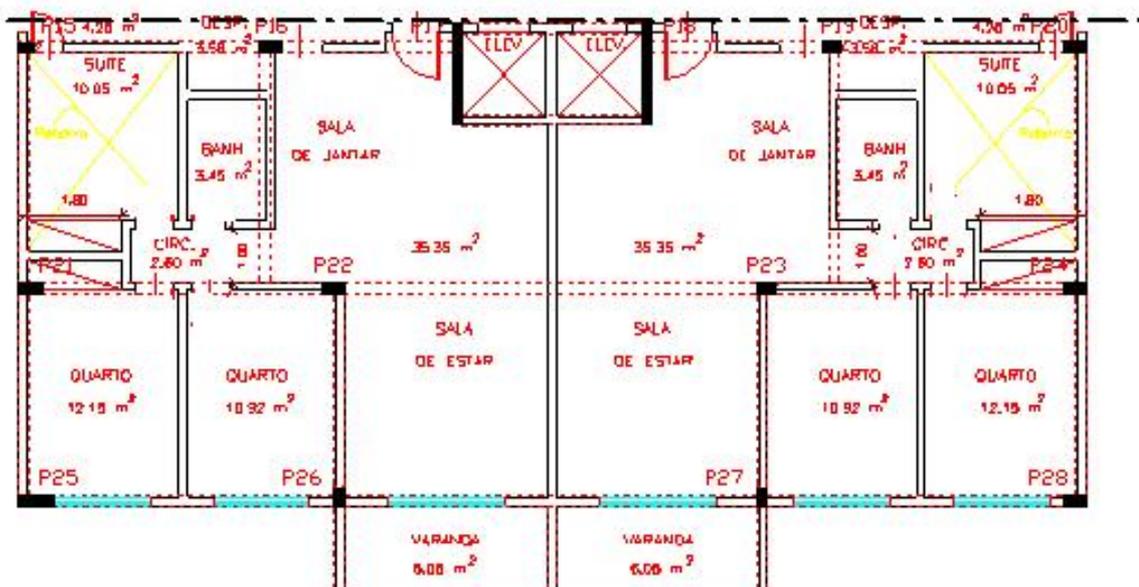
Planta de arquitetura integrada com a planta de fôrmas
